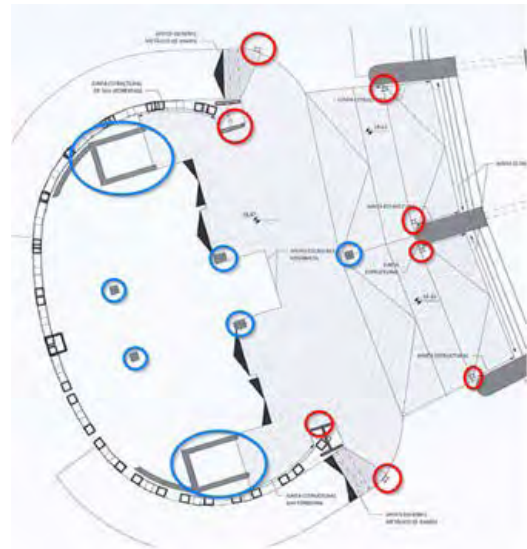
Planta tipo. Apoyos en elementos verticales de hormigón y metálicos.
